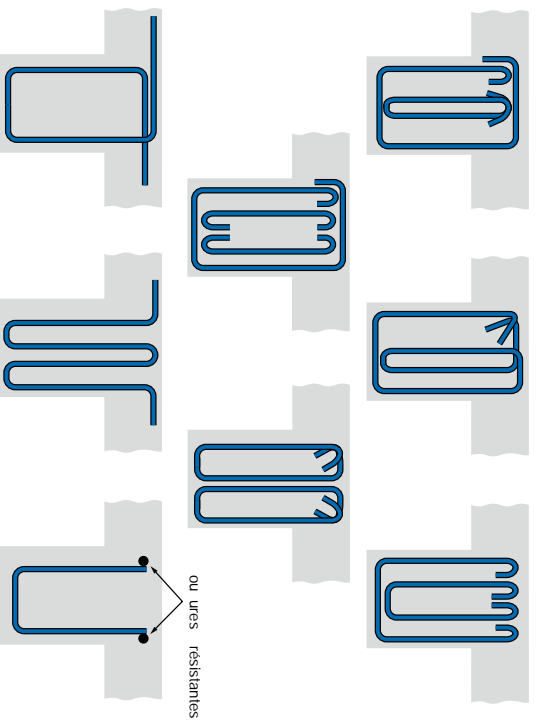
armatures transversales de poutres fléchies. Exemples de dispositions conformes à la norme NF EN 1992-1-1.
